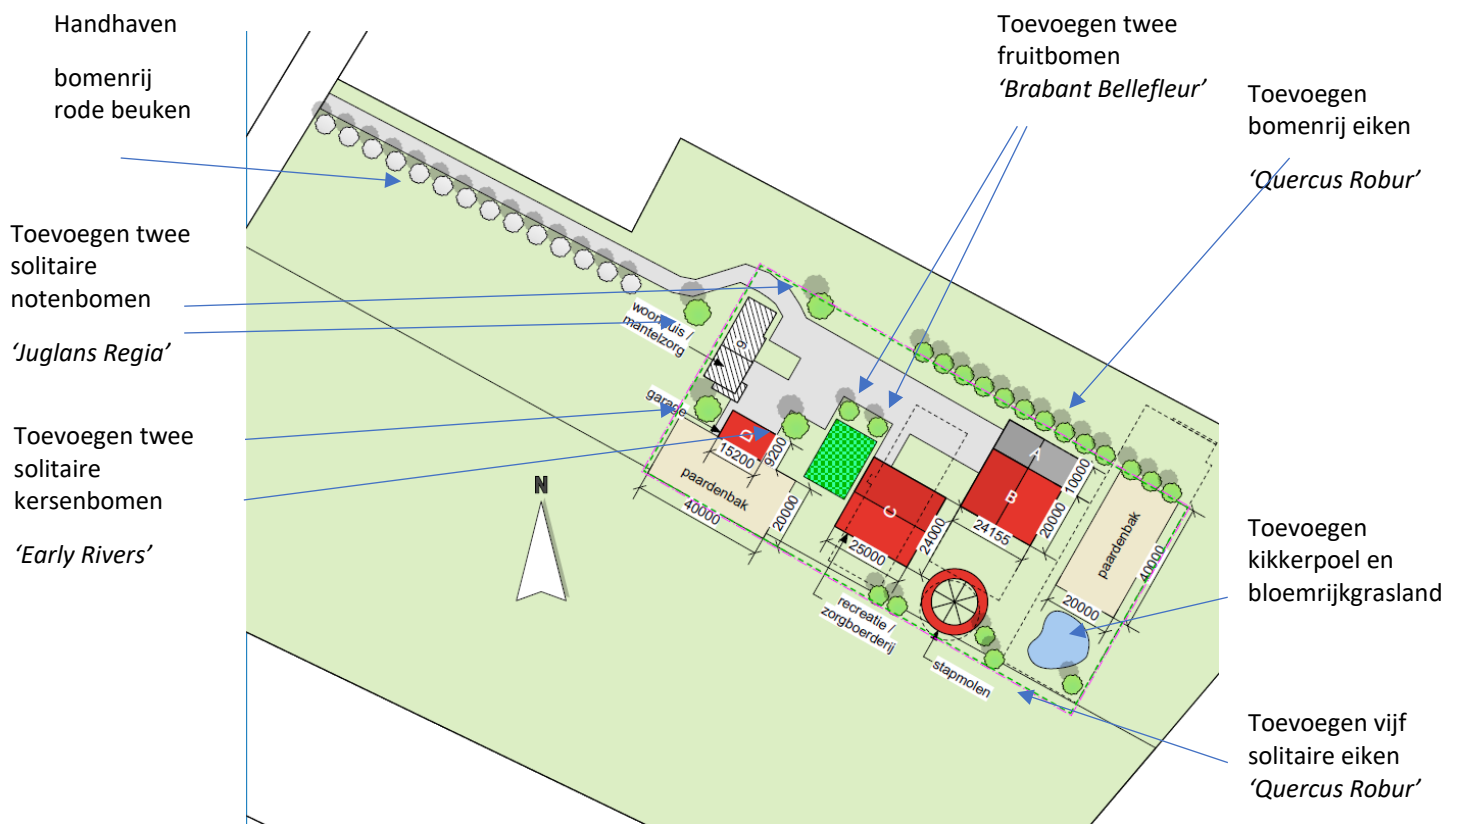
Overzicht belangrijkste groen-blauwe elementen rondom het plangebied (gele lijn is plangebied).
